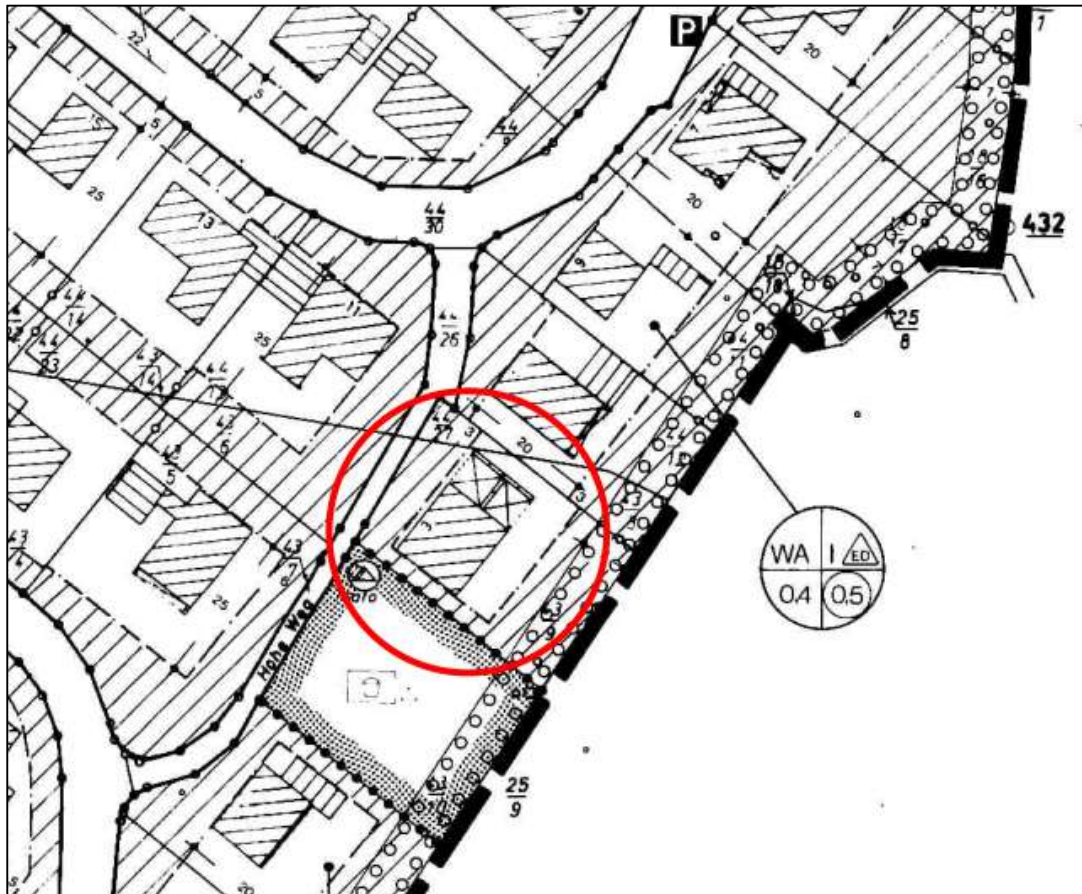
Ausschnitt Plangebiet Bebauungsplan Nr. 5
